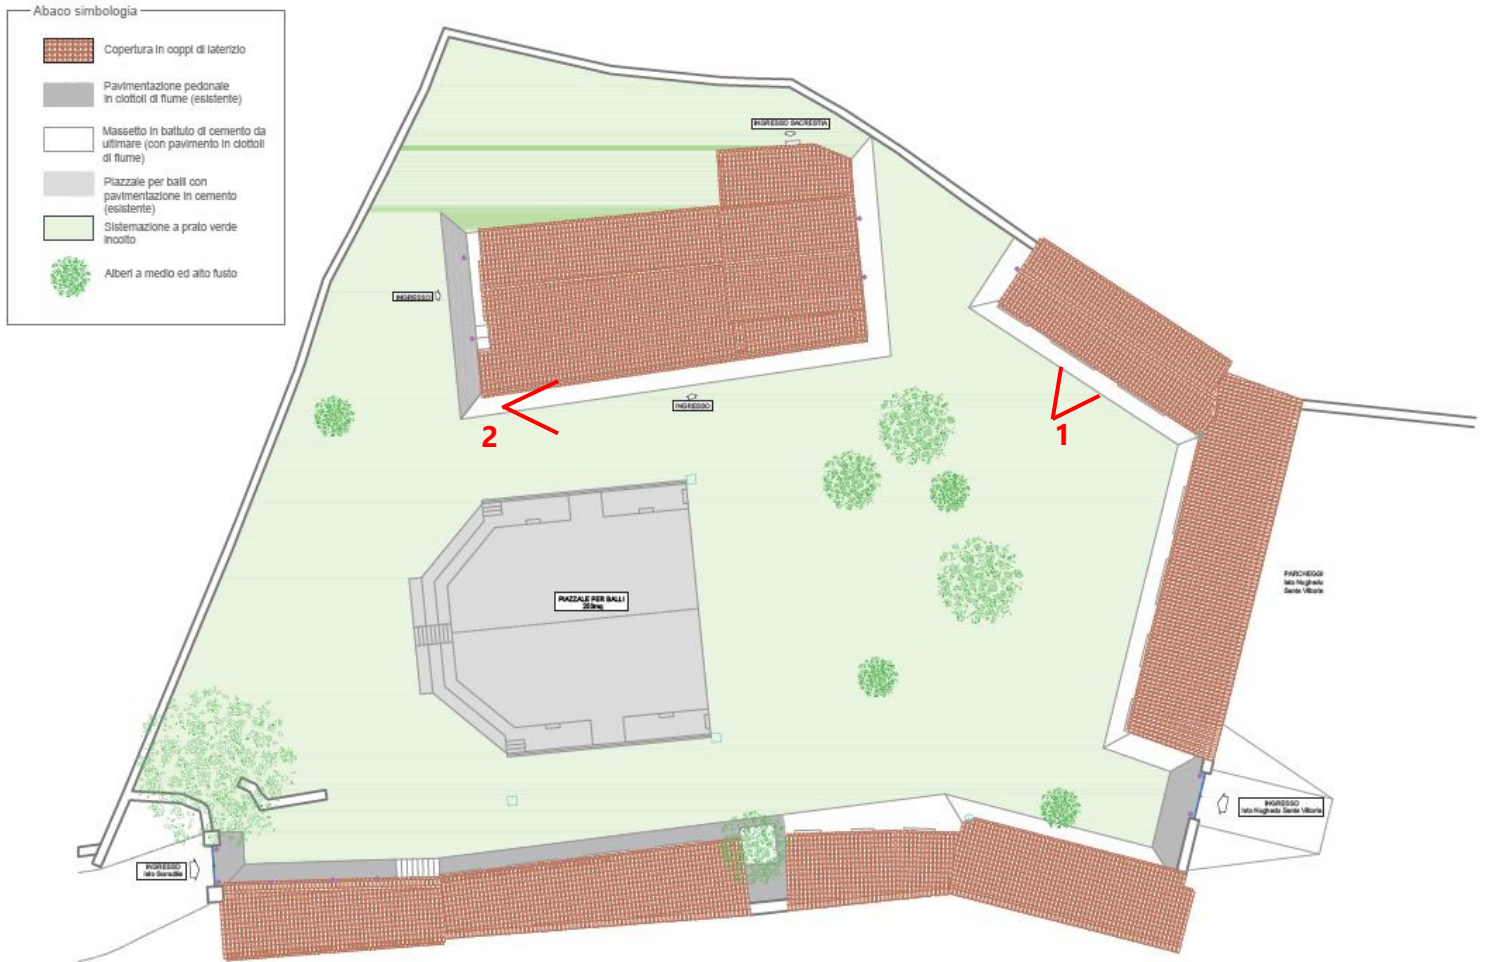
Planimetria generale dell'area d'intervento con indicazione dei punti di presa fotografica.
